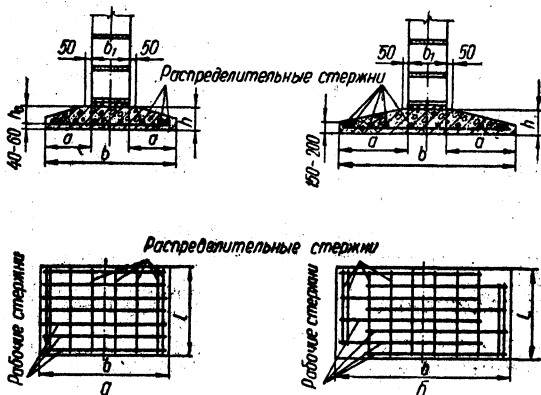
Армирование сборных железобетонных блоков сварными сетками:
